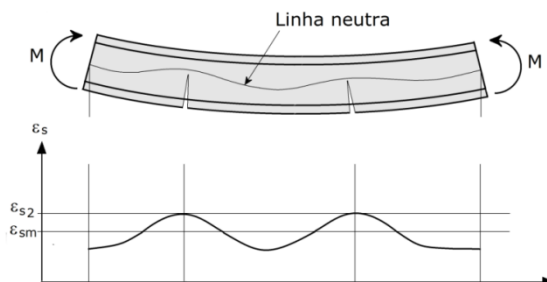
Elemento de concreto armado fissurado submetido à flexão.
